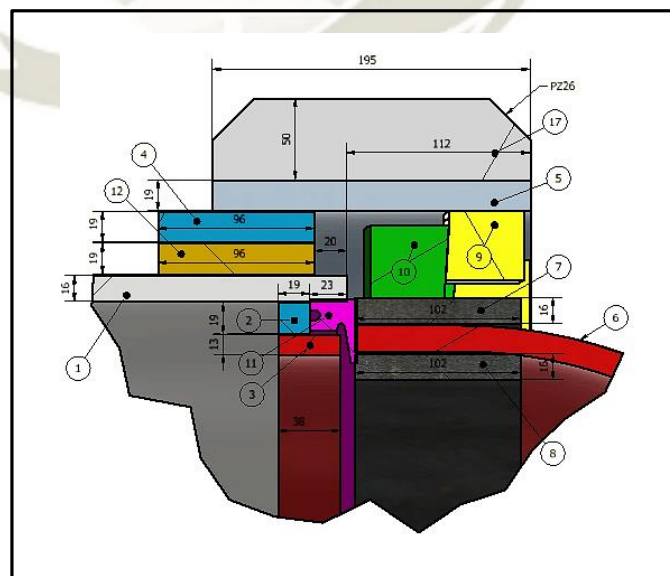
Vista Detalle Sistemas de Cerrado de Compuerta
